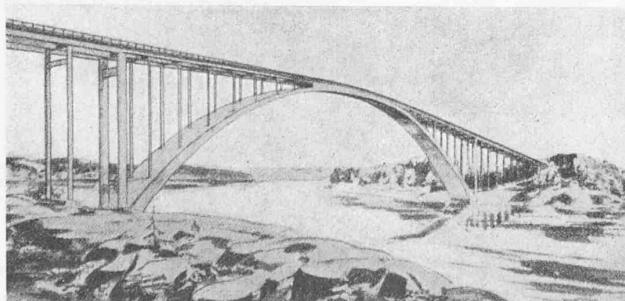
Sandö-Brücke. Ansicht des 264 m weit gespannten Eisenbetonbogens über den rechten Flussarm. Gesamtlänge 843 m, Betonmasse rd. 10 000 m<sup>3</sup>, Stahleinlagen rd. 1050 t
